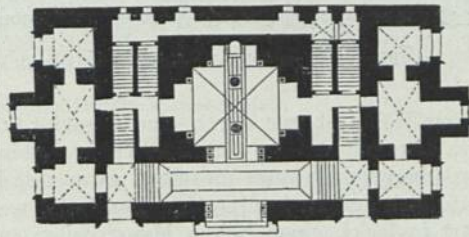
Grundriss der Zisa bei Palermo
